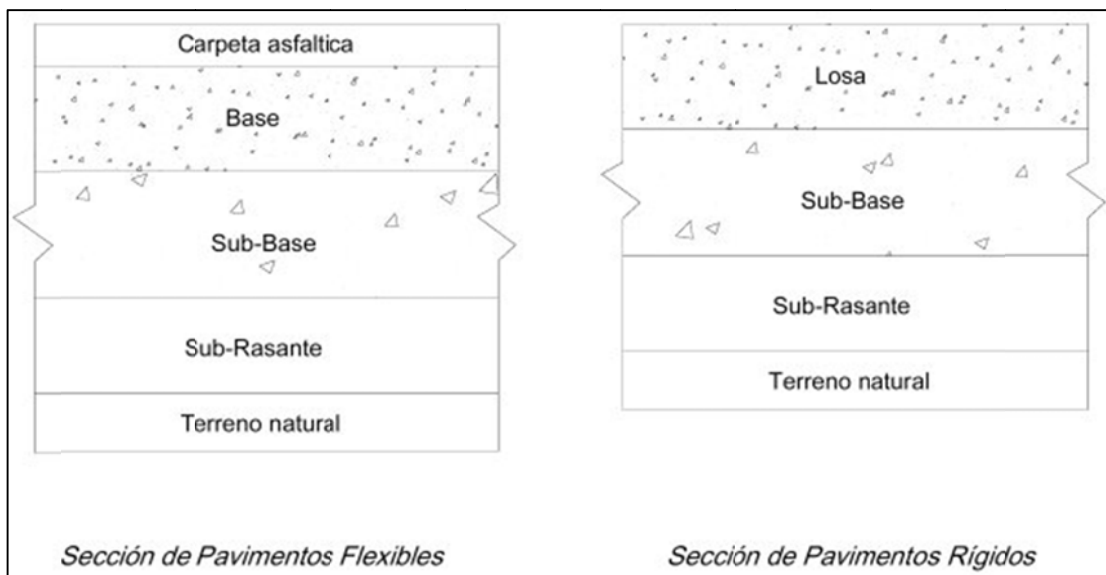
Esquemas de estructuras de pavimentos flexibles y rígidos
